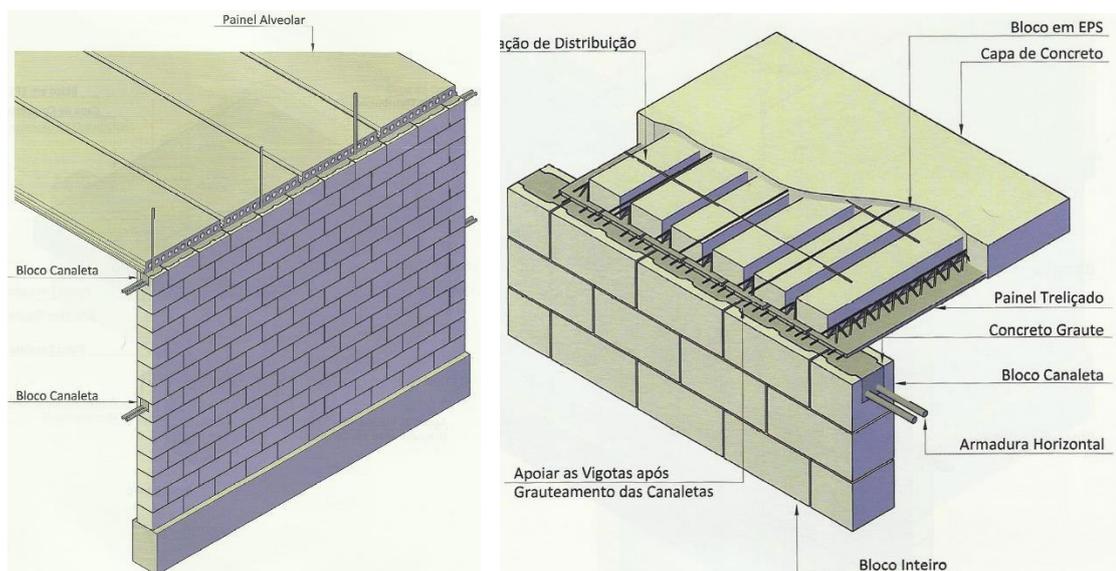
Processo de construção de laje alveolar apoiada em parede estrutural e de laje treliçada mista com EPS, respectivamente. Fonte: NESE e TAUIL, 2010, montagem da autora.
